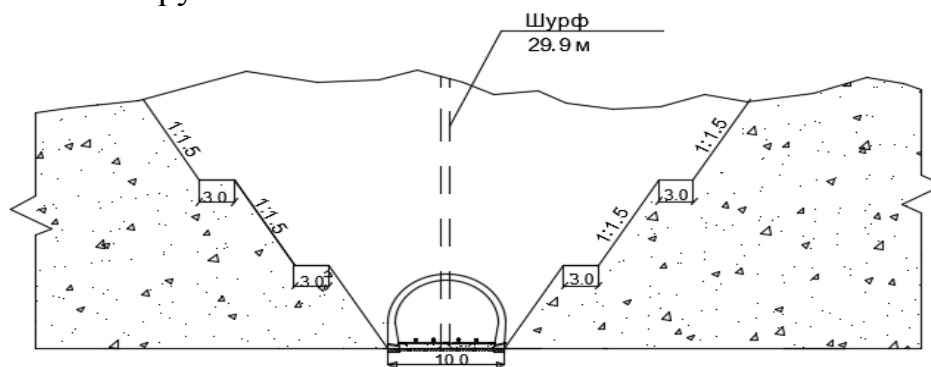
Вариант бестоннельной прокладки железнодорожного пути
